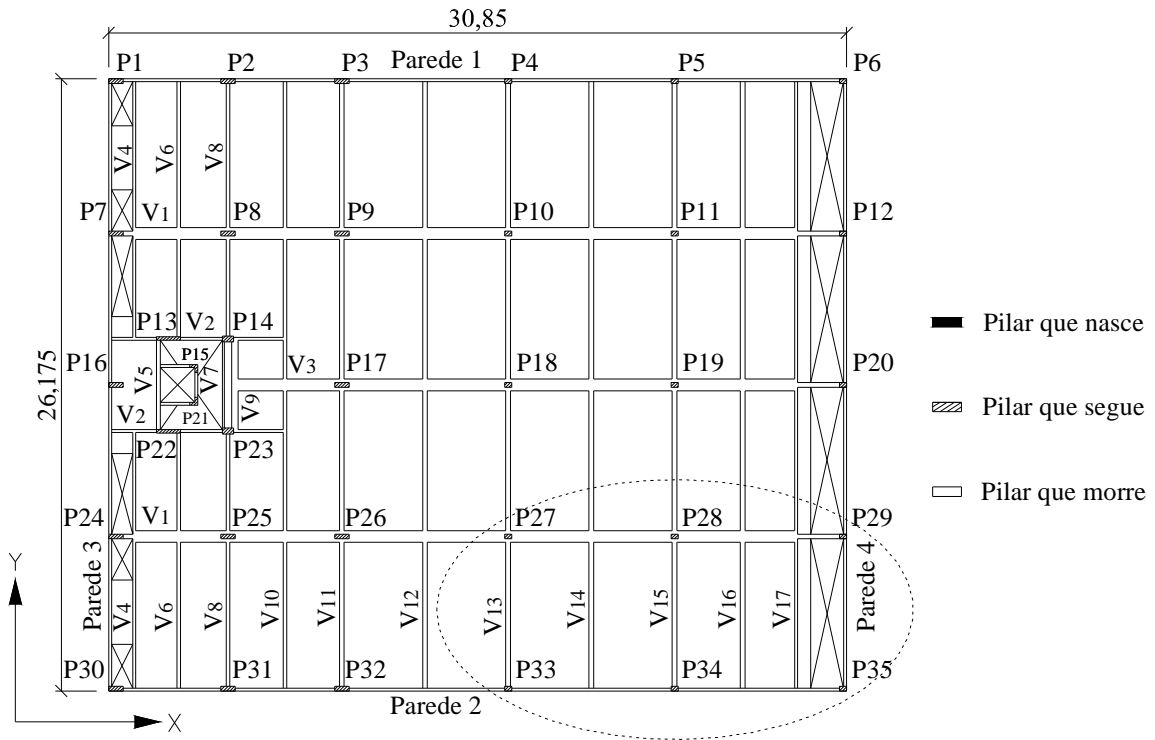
Estrutura do pavimento térreo com o trecho analisado em destaque (dimensões em metros).
